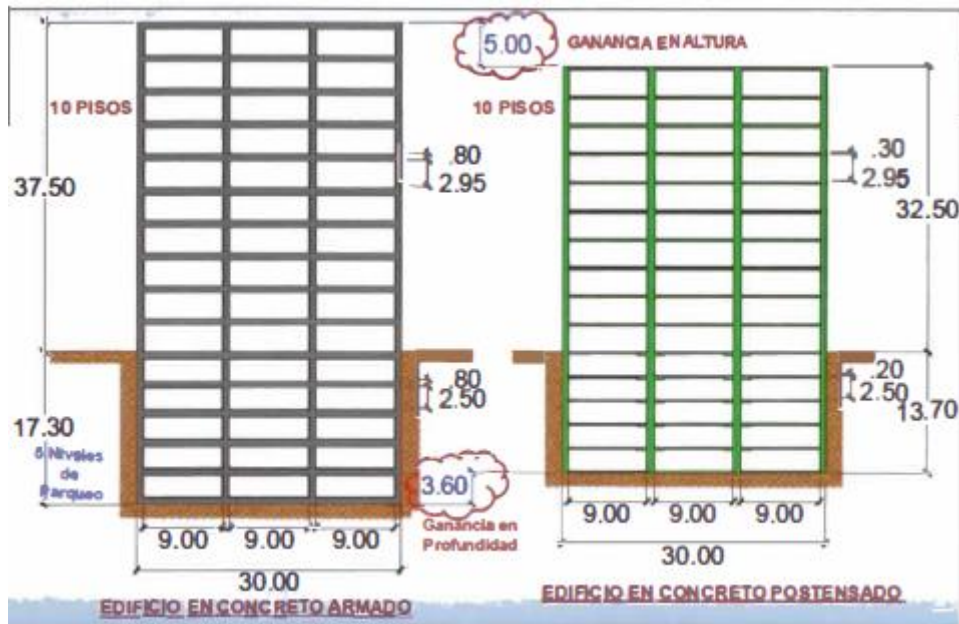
Esquema comparativo del concreto postensado con el concreto armado en edificaciones (Samayca Ingenieros SAC - Lima 2014)
